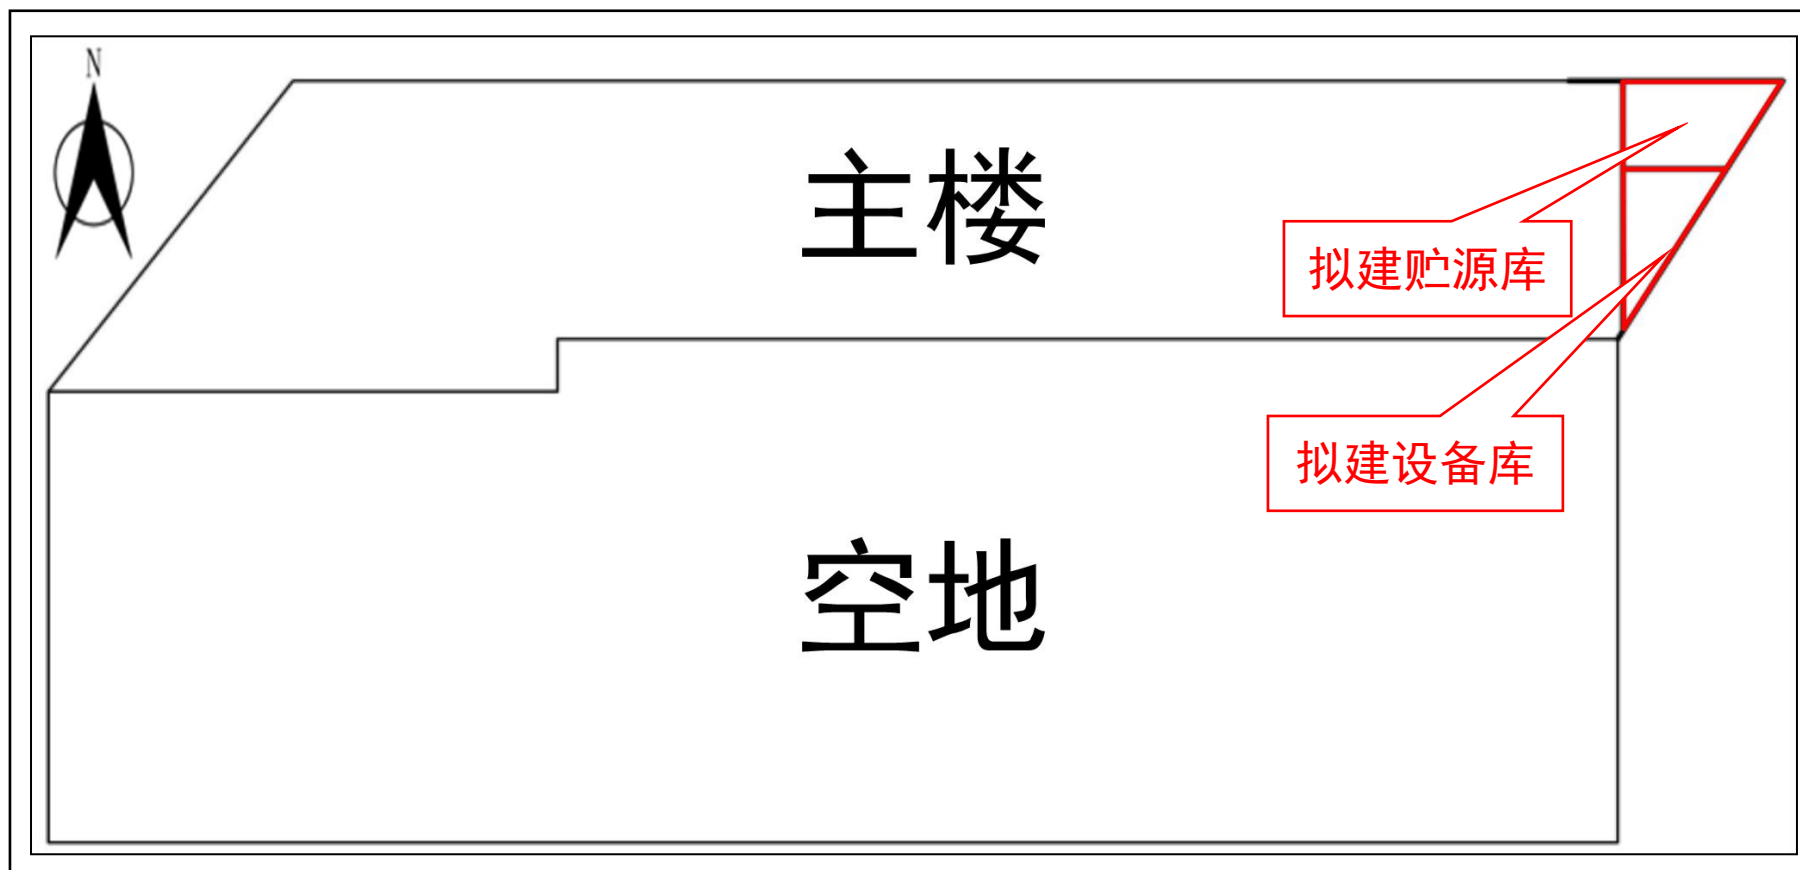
山东圣达工程检测有限公司厂区总平面布置示意图
